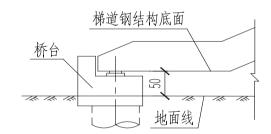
Recommended stairway flooring arrangement (cm) 图 13. 建议梯道落地布置方式(厘米)
